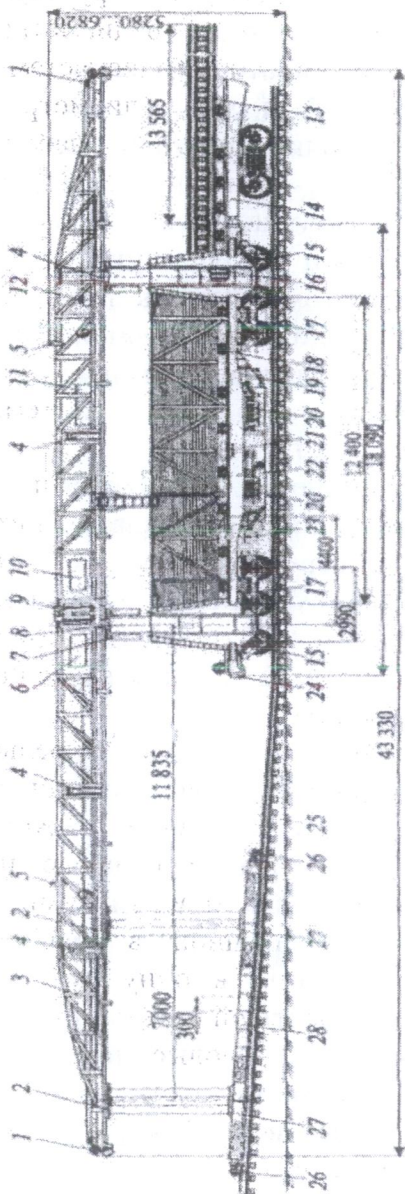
Укладочный кран УК-25/9-18: 1 – обводной блок; 2 – грузовой тележка; 3 – стрела; 4 – откидная балка опоры стрелы; 5 – отбойная изолирующая лыжа; лебедка; 6 – грузовая, 10 – тяговая, 23 – для перетяжки пакетов звеньев; 7 – опорное устройство для перетяжки стрелы; 8 – выдвигная каретка; 9 – пост управления крановым оборудованием стрелы; 11 – крановое электрооборудование; 12 – ограничитель грузоподъемности; 13 – пакет звеньев путевой решетки; 14 – платформа прикрытия или моторная платформа (УК-25/9-18 МП); 15 – порталная стойка; 16 – гидrocилиндр подъема стрелы; 17 – задняя и передняя ходовые тележки; 18 – роликовый транспортер; 19 – топливный бак; 20 – дизель-электрический агрегат; 21 – нижний пост управления передвижением крана и лебедками перетяжки пакетов звеньев; 22 – рама платформы крана; 24 – жесткая автосцепка; 25 – укладываемое звено путевой решетки; захватная траверса; 26 – рельсовый захват; 27 – нижняя блоковая подвеска полиста; 28 – траверса
